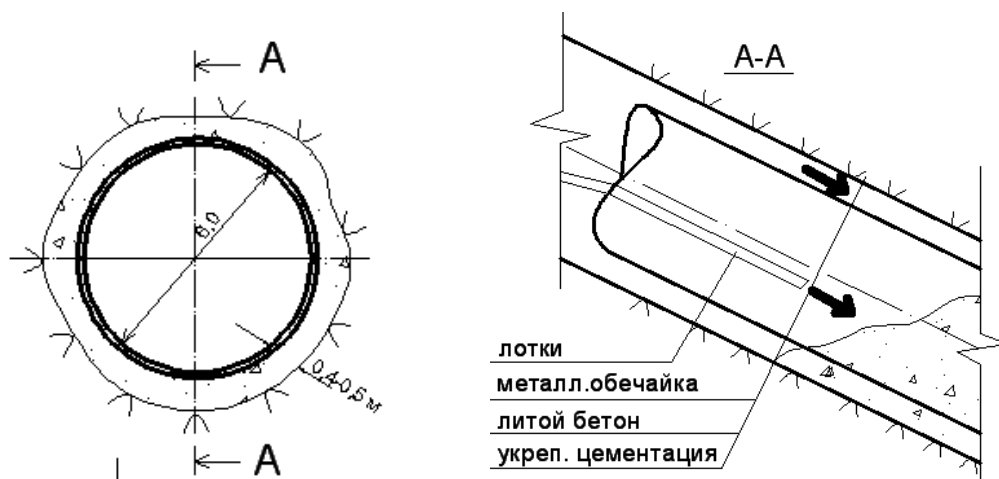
Водовод Нурекской ГЭС, забетонированный с помощью литой бетонной смеси
